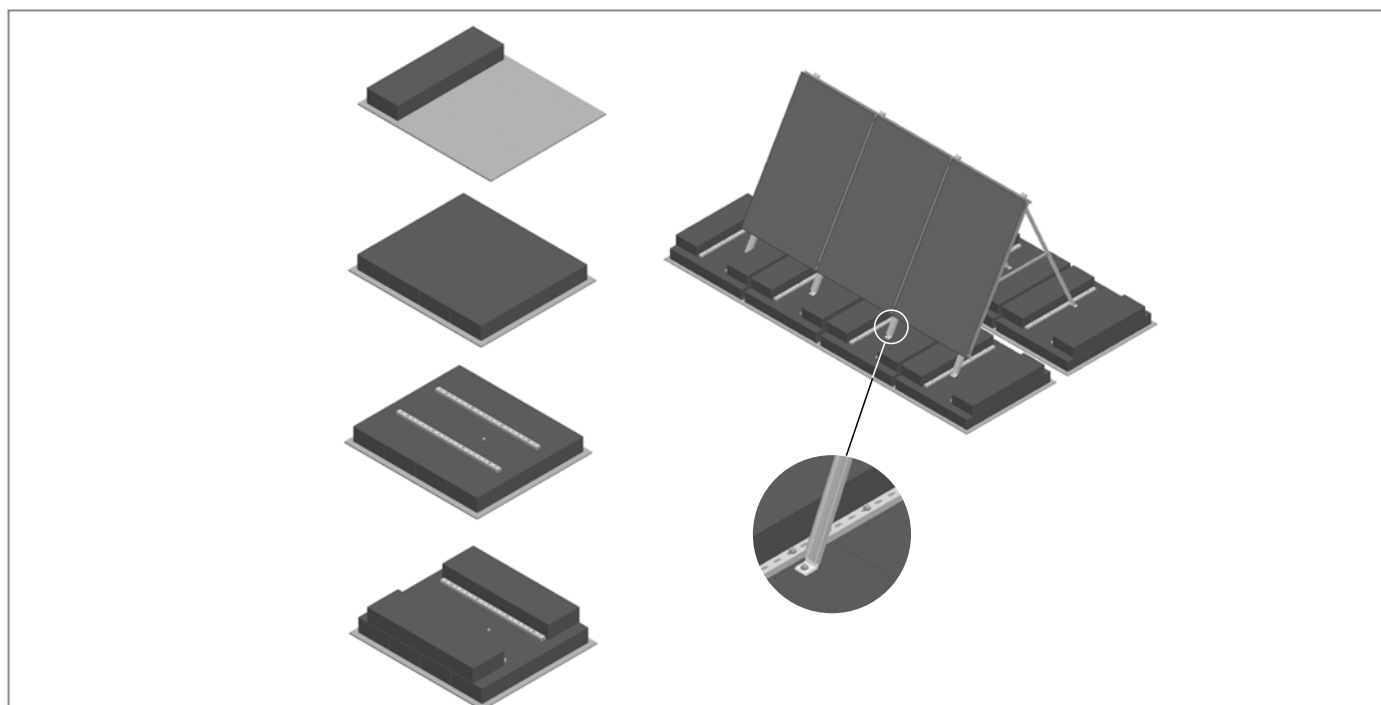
Montage auf Beton- Blockstufensteinen, Verschraubung mit Bolzenanker
